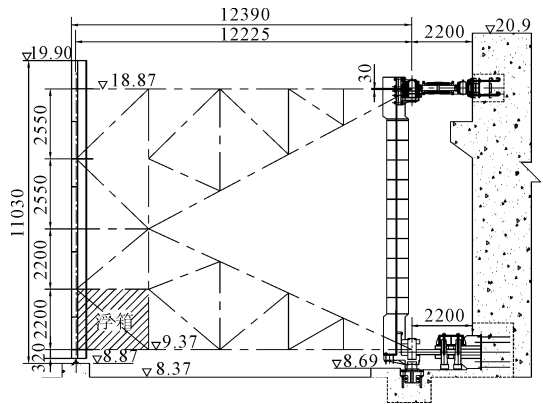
下闸首三角门立面布置图(高程:m,尺寸:mm)
